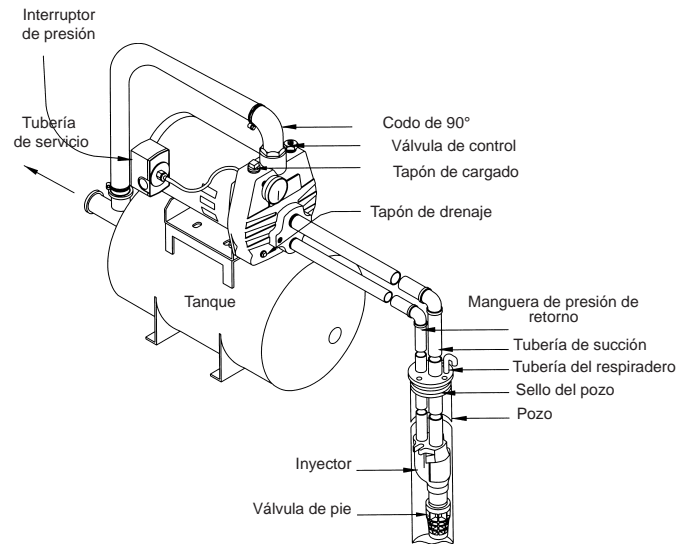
POZO PROFUNDO - SISTEMA MONTADO EN EL TANQUE (INSTALACIÓN CON TUBERÍA DOBLE CON VÁLVULA DE PIE)
